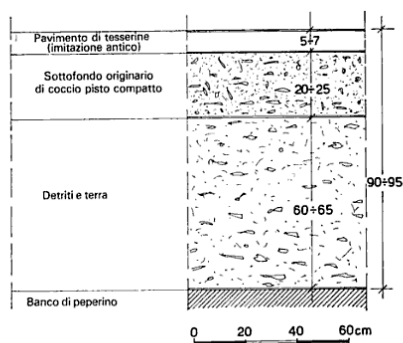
Sezione del pavimento termale antico della chiesa di Santa Maria, compatto e pesante, favorevole alla condensazione.
